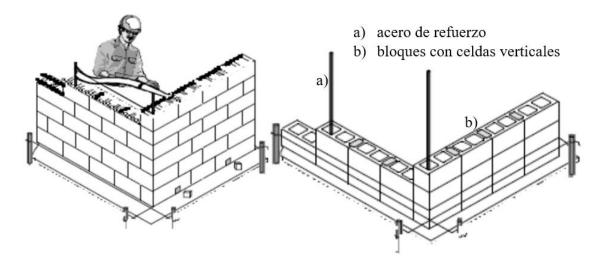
Esquema de armado de la mampostería estructural donde se muestra a) el acero de fuerzo y b) y los bloque con perforaciones verticales (Gutierrez, 2003).
